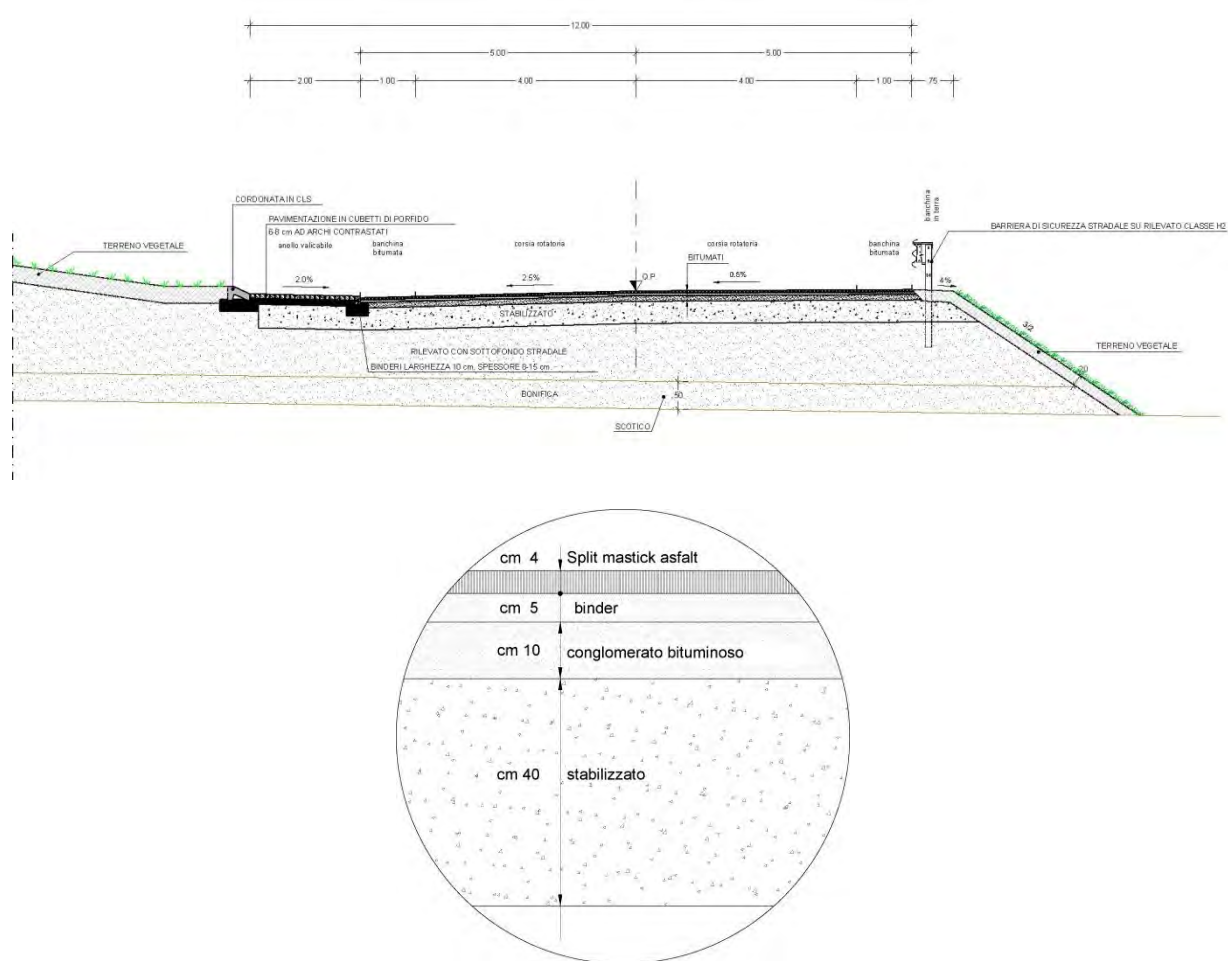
Sezione tipo rotatoria e pacchetto stradale
